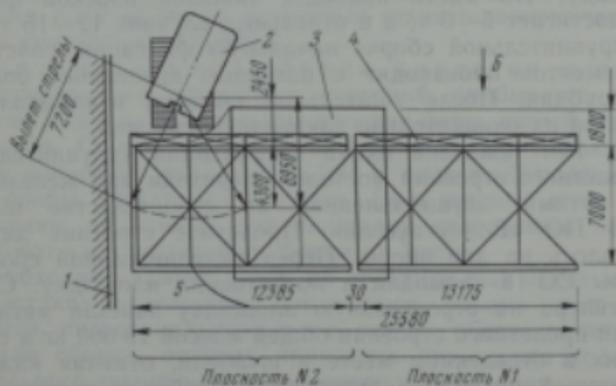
Монтаж гибкой опоры комплексным методом 1 — стена обогатительной фабрики; 2 — кран РДК-25; 3 — фундаменты; 4 — место укрупнительной сборки; 5 — расчалки
